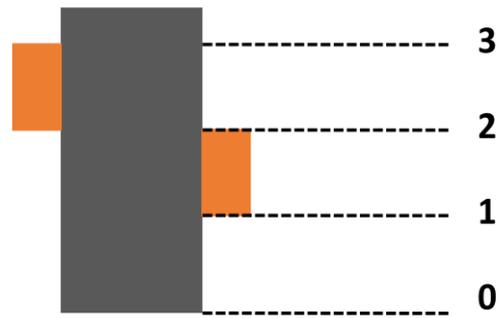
les encorbellements vu sur la façade, source : Auteur.
